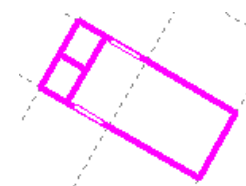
Отверстия в стенах (фрагмент плана)
